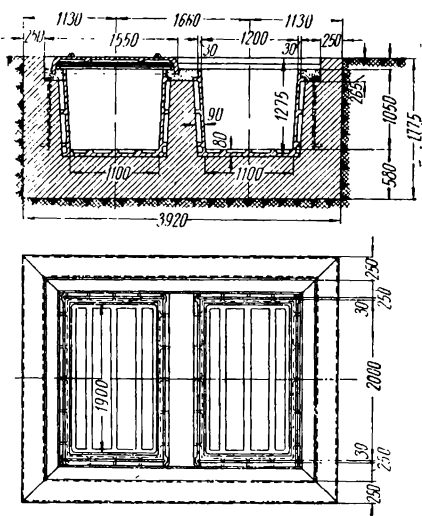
Конструкция неотапливаемых колодцев для охлаждения заготовок, сортового металла после проката и поковок
